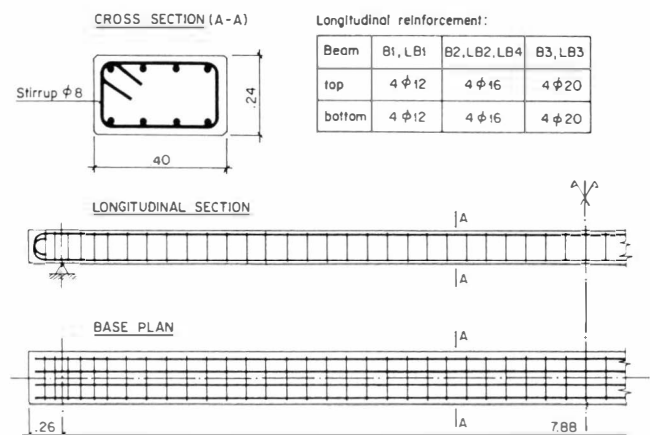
Abmessungen und Bewehrungen der schlaff bewehrten Versuchs balken – Dimensions et armatures de la poutre d'essais armée à l'aide d'armature passive – Dimensions and reinforcements of the non-prestressed test beams
